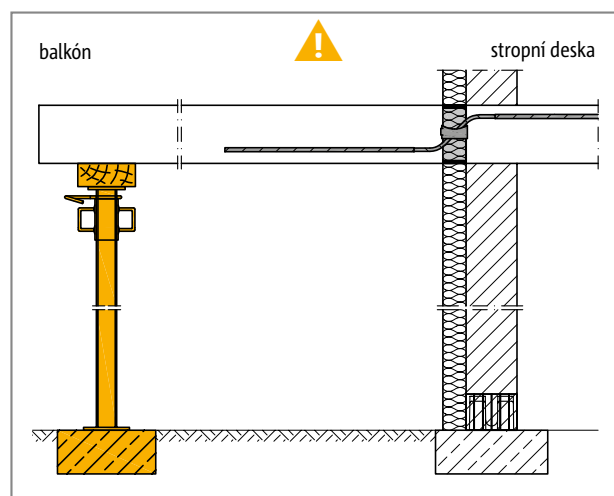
Schöck Isokorb® T typ QL/QP: Isokorb® T typ QL/QP zabudovaný nad filigránovou desku
